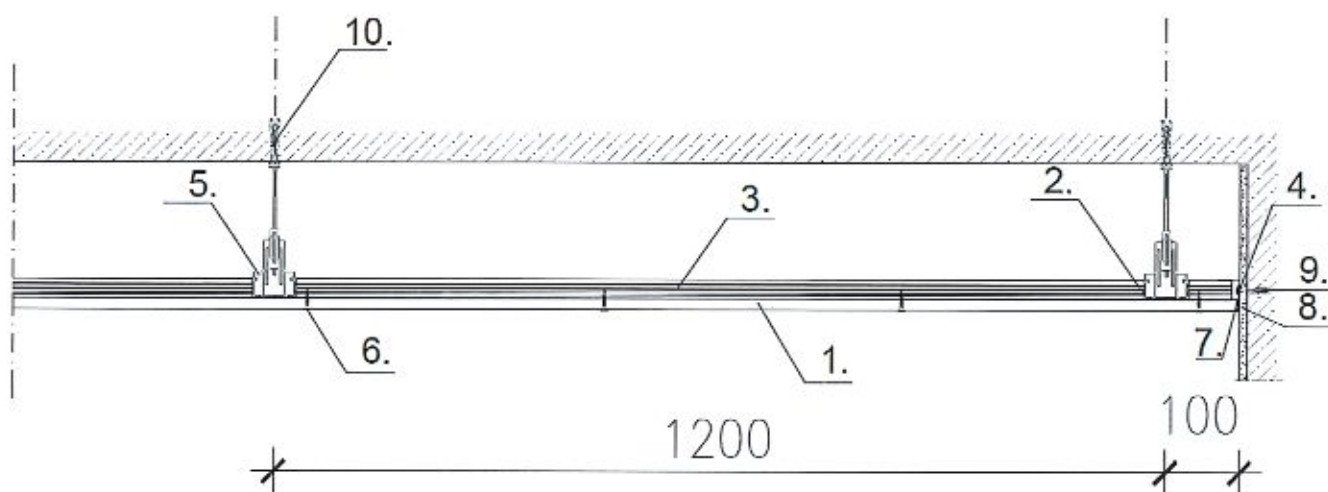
Widok sufitu podwieszanego – konstrukcja krzyżowa jednopoziomowa
